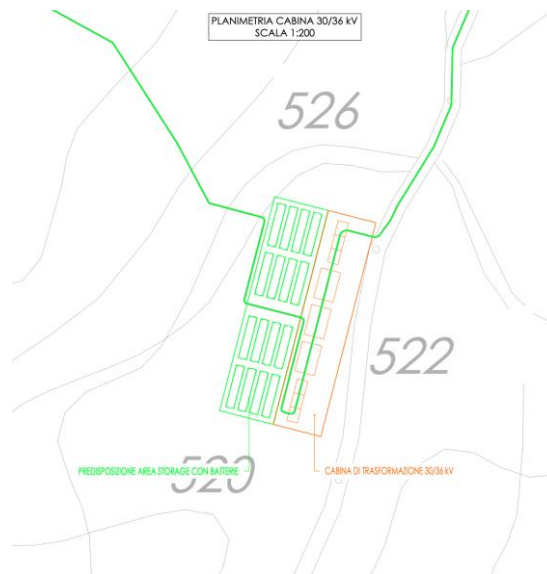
SSE Planimetria cabina trasformazione 30-36 kV e Storage progetto iniziale
